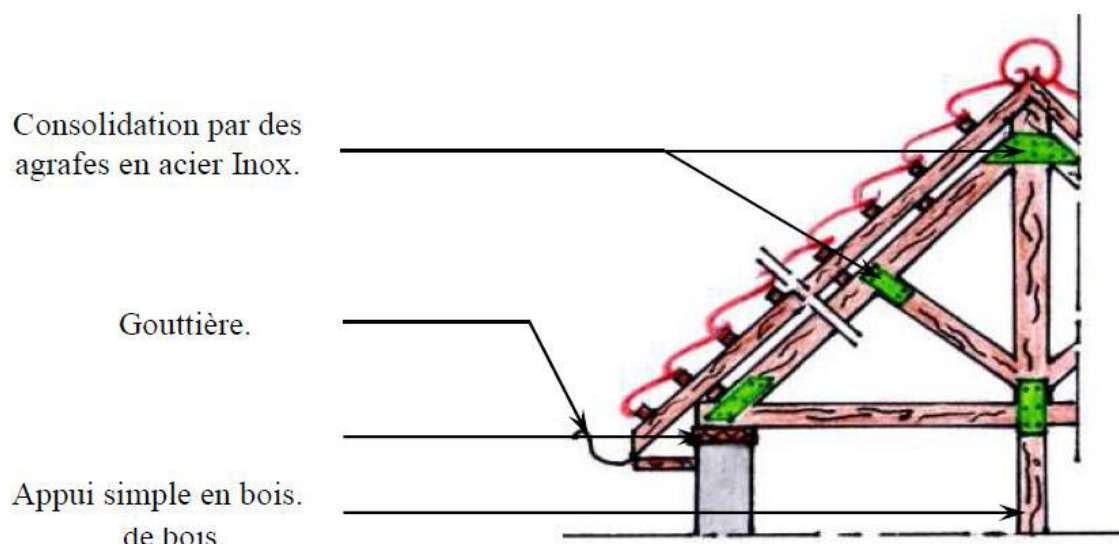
Réparer les défauts d'assemblage de la charpente
